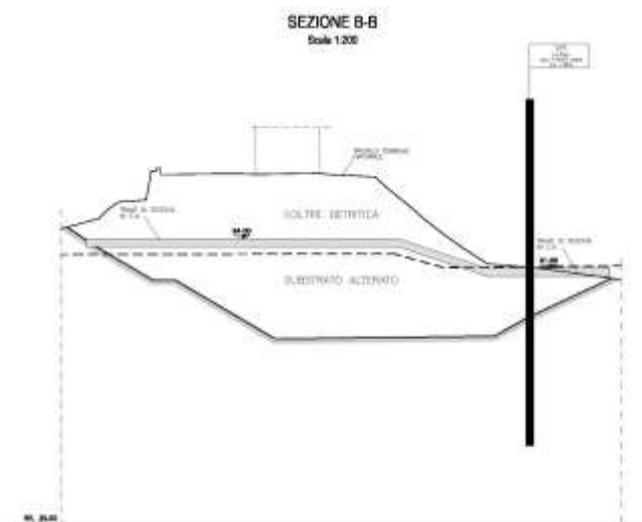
Ricostruzione stratigrafica area di cantiere: sezione zona Paratia A
